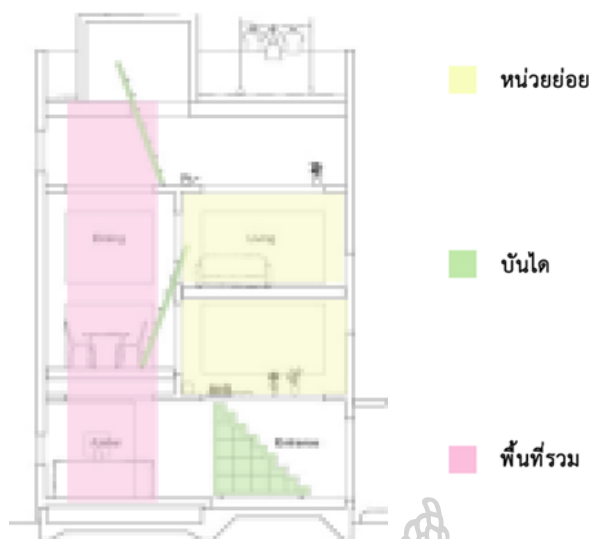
กรณีศึกษาที่ 6 House T
